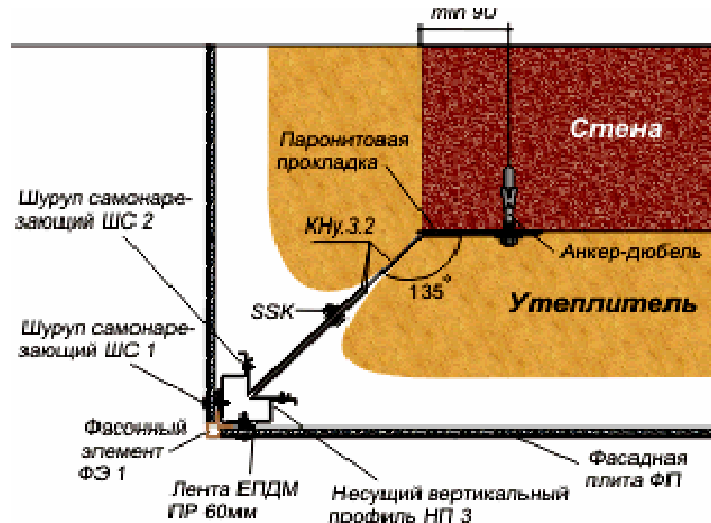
Крепления фасадной плиты на угол здания (1-й вариант)
